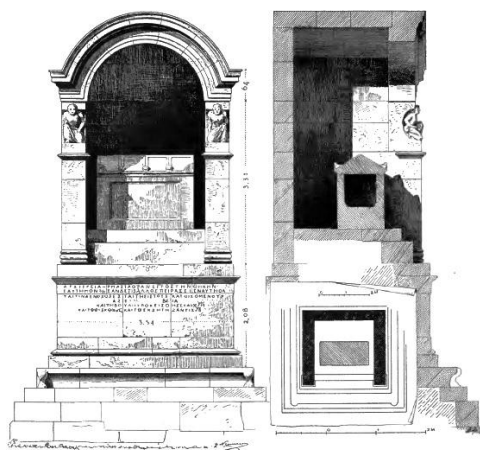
Außen, Schnitt und Grundriss von Grabmäler der Armasta.
